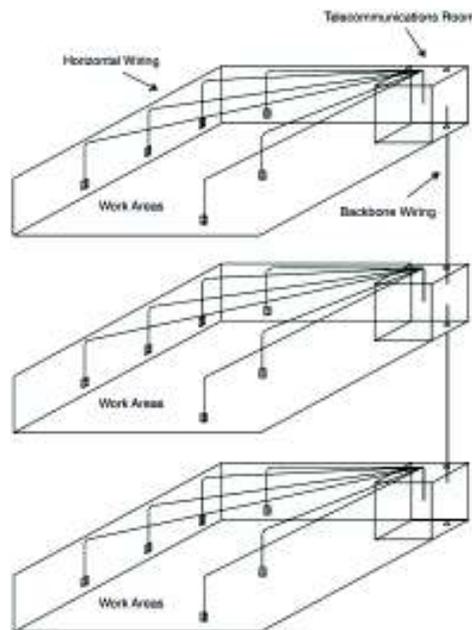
Subsistemas del cableado estructurado (Trulove, 2006)
